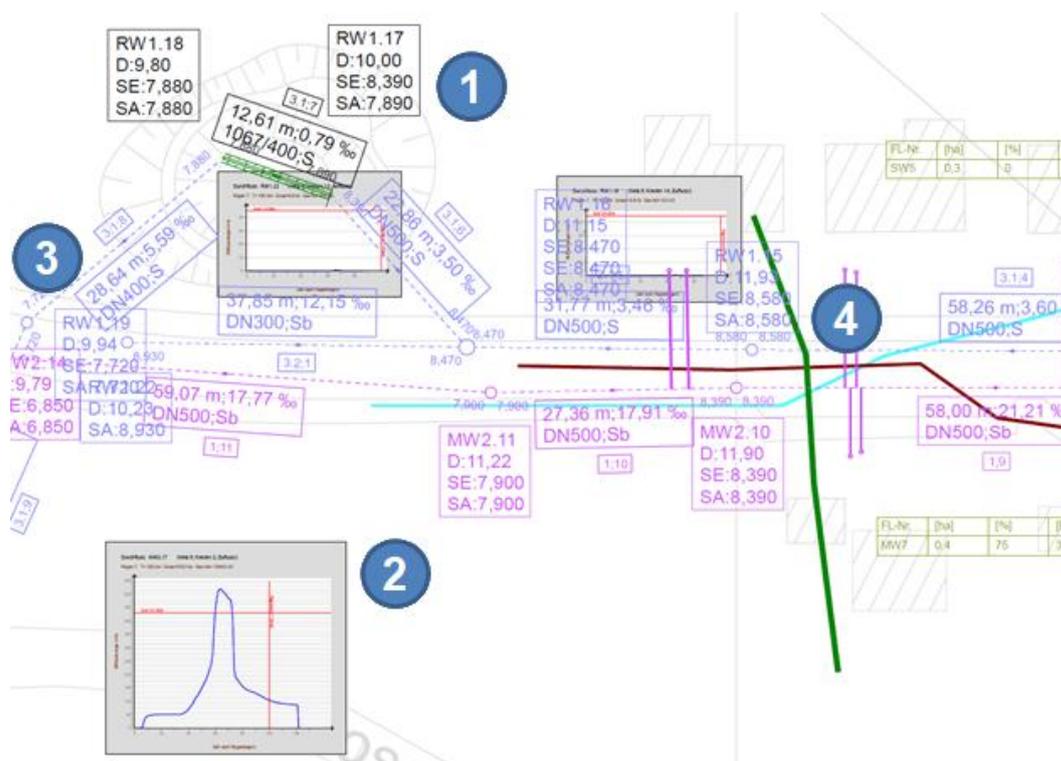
Ausschnitt Kanallageplan
